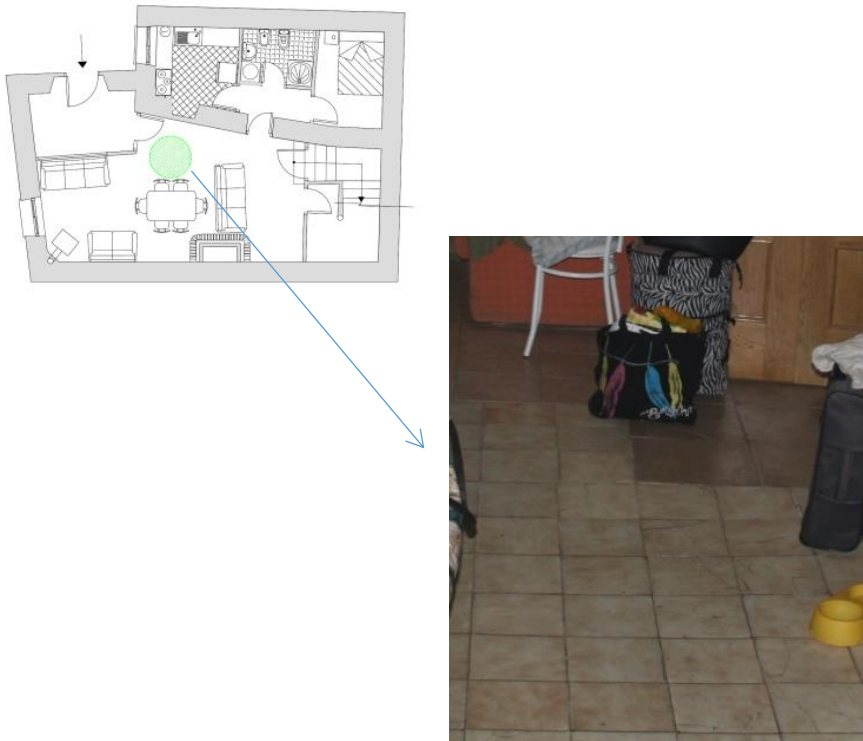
Desnivel del pavimento en el comedor en planta baja. 2017. Fuente: Autor.
